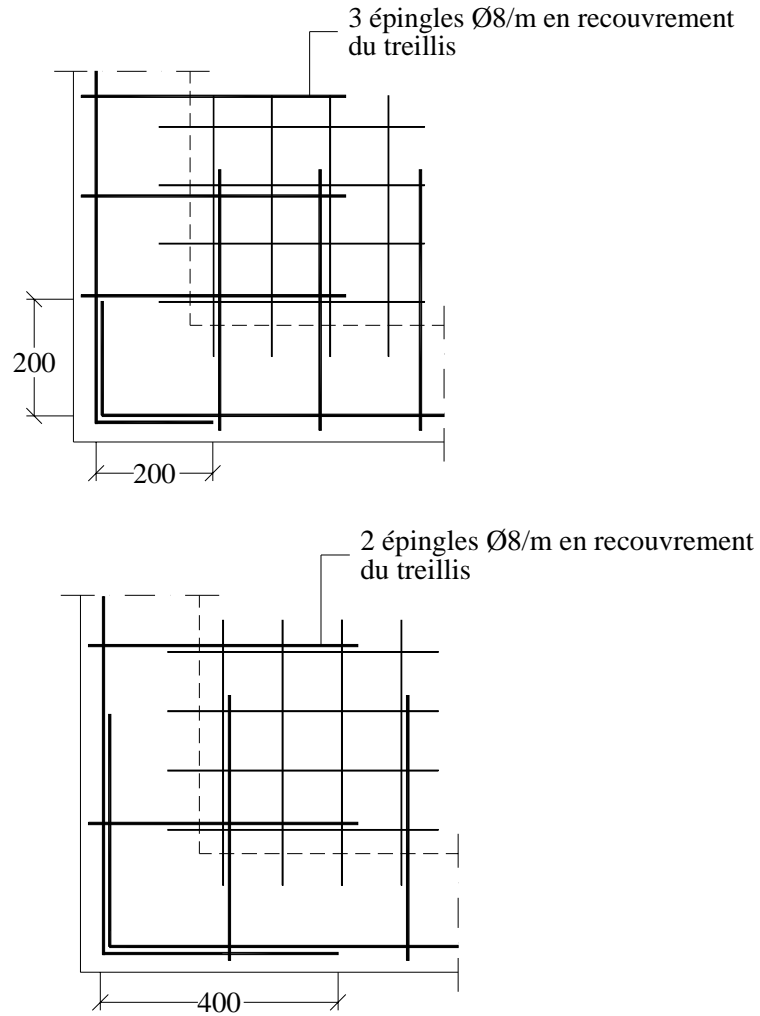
Armature d'angle du chaînage. Liaison entre mur extérieur et mur extérieur.
